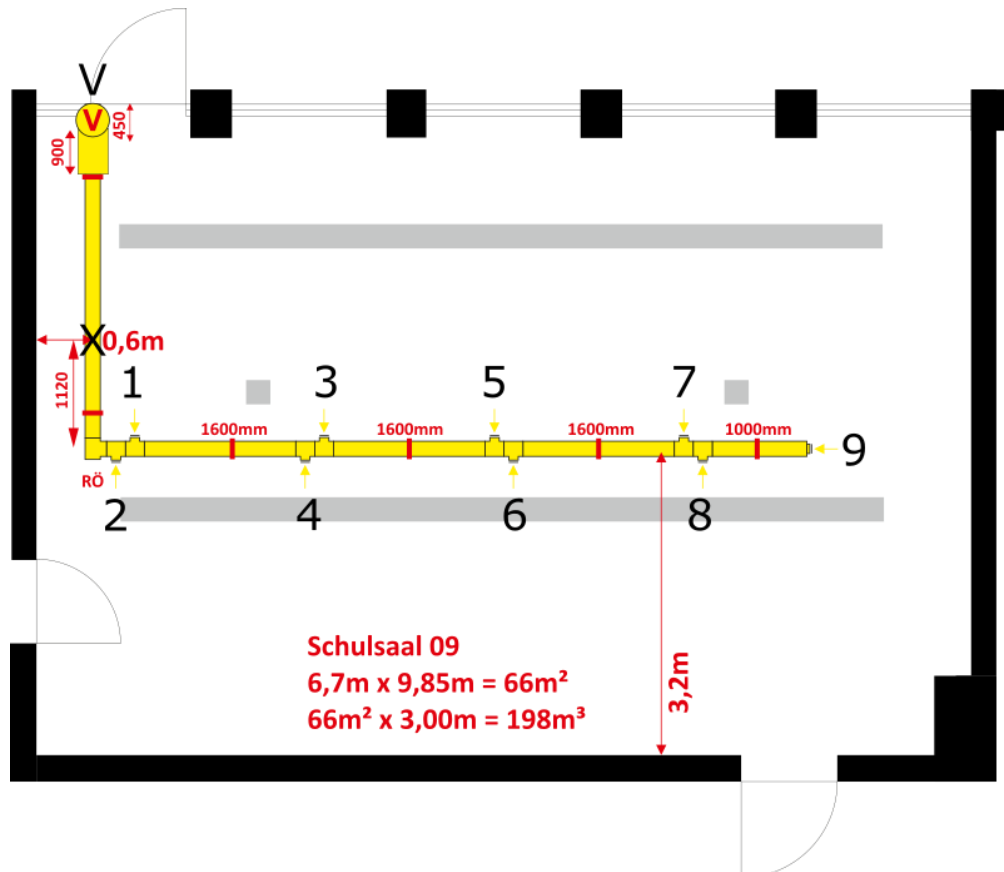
Grundriss GSR-A09 mit Abluftanlage und Messstellen
